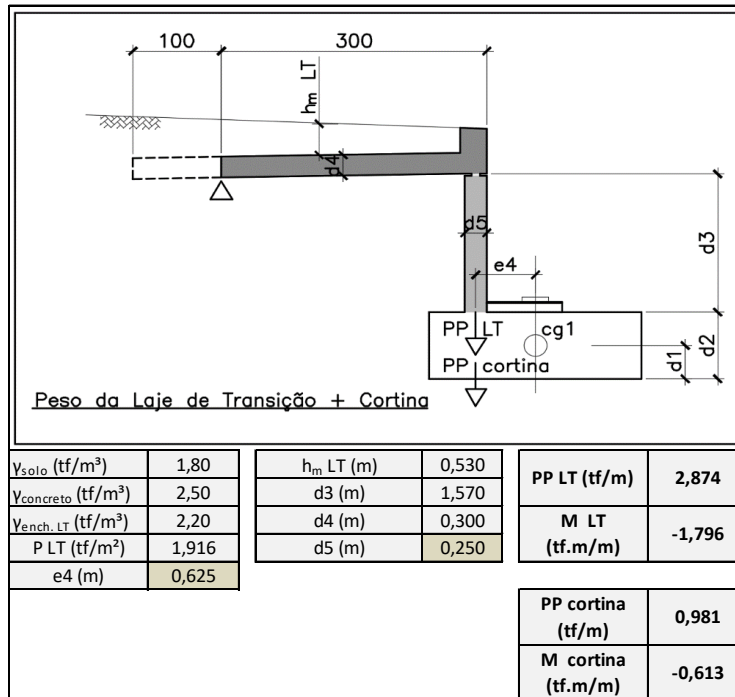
CARREGAMENTO LAJE DE TRANSIÇÃO
